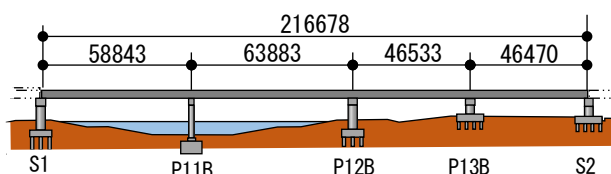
解析対象の鋼箱桁橋側面図 (単位 mm)
